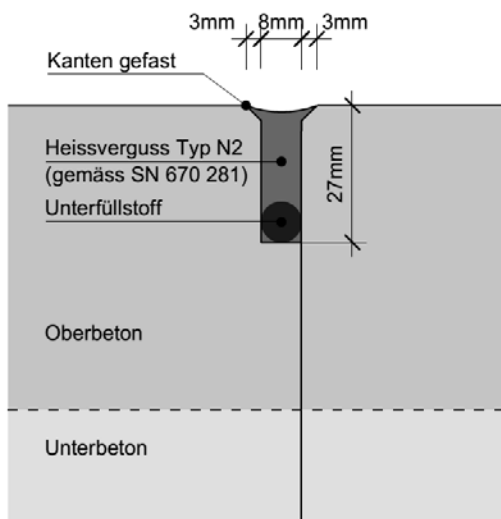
Detail 2 mit ungefräster Fuge (Längsfuge)
